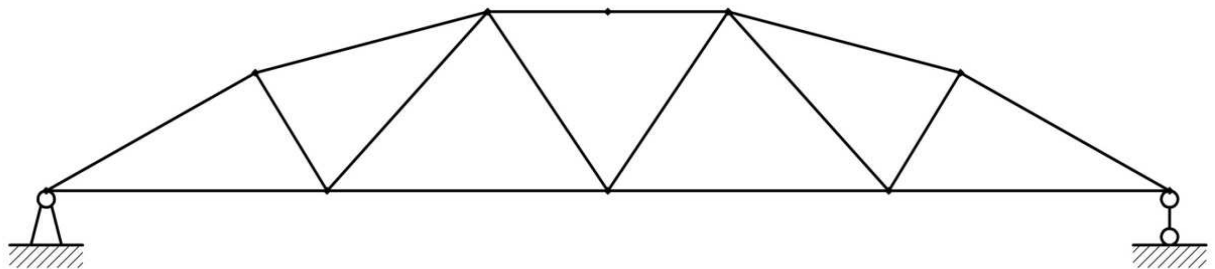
Закрепление опорных узлов сегментной фермы
